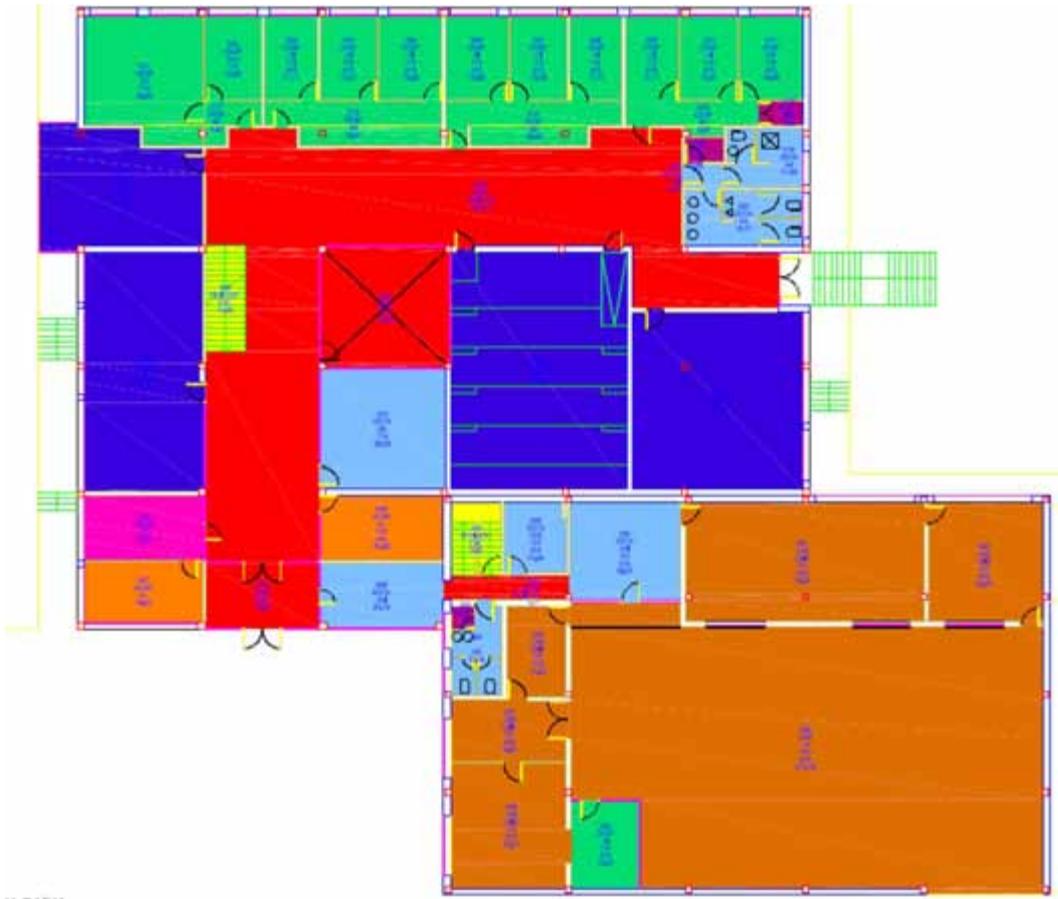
Planta Baja del Edificio Fundición de la EEI.
